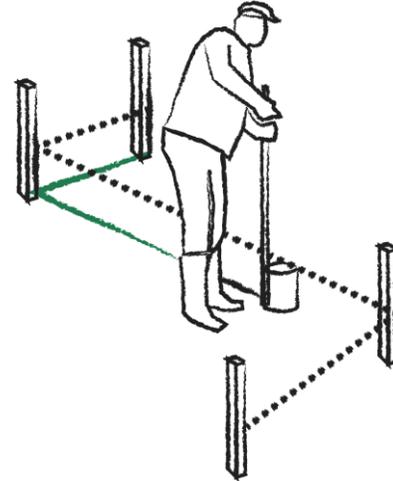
Trazo para zanja de instalación sanitaria. Fuente: elaboración propia.
